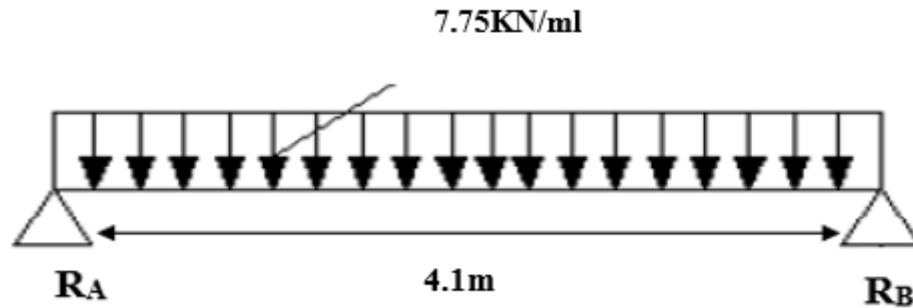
schéma statique de la poutre chainage a l'ELS
